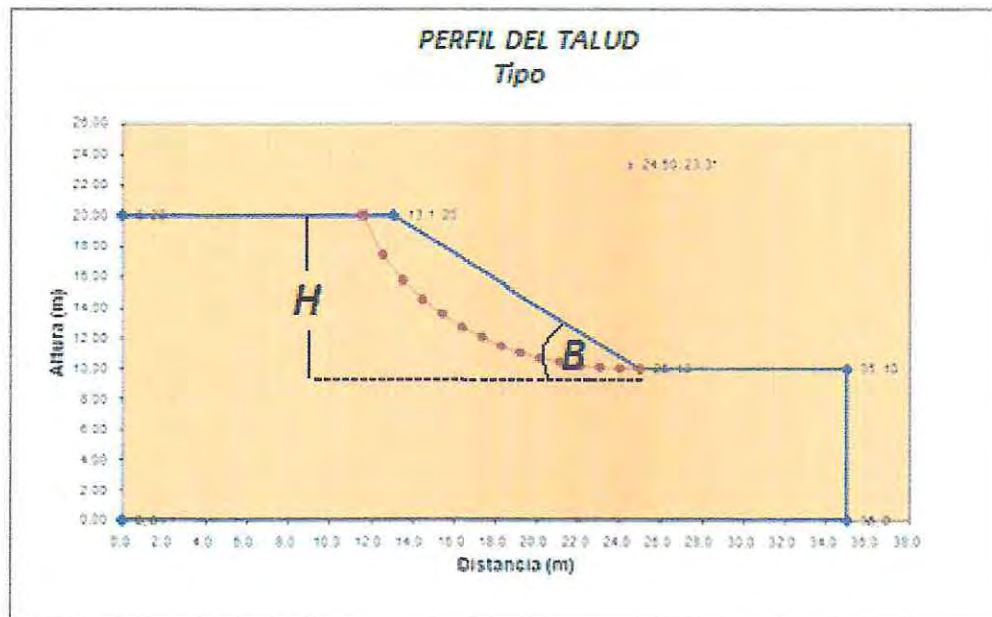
Geometría Perfil Tipo Sin Infiltración
